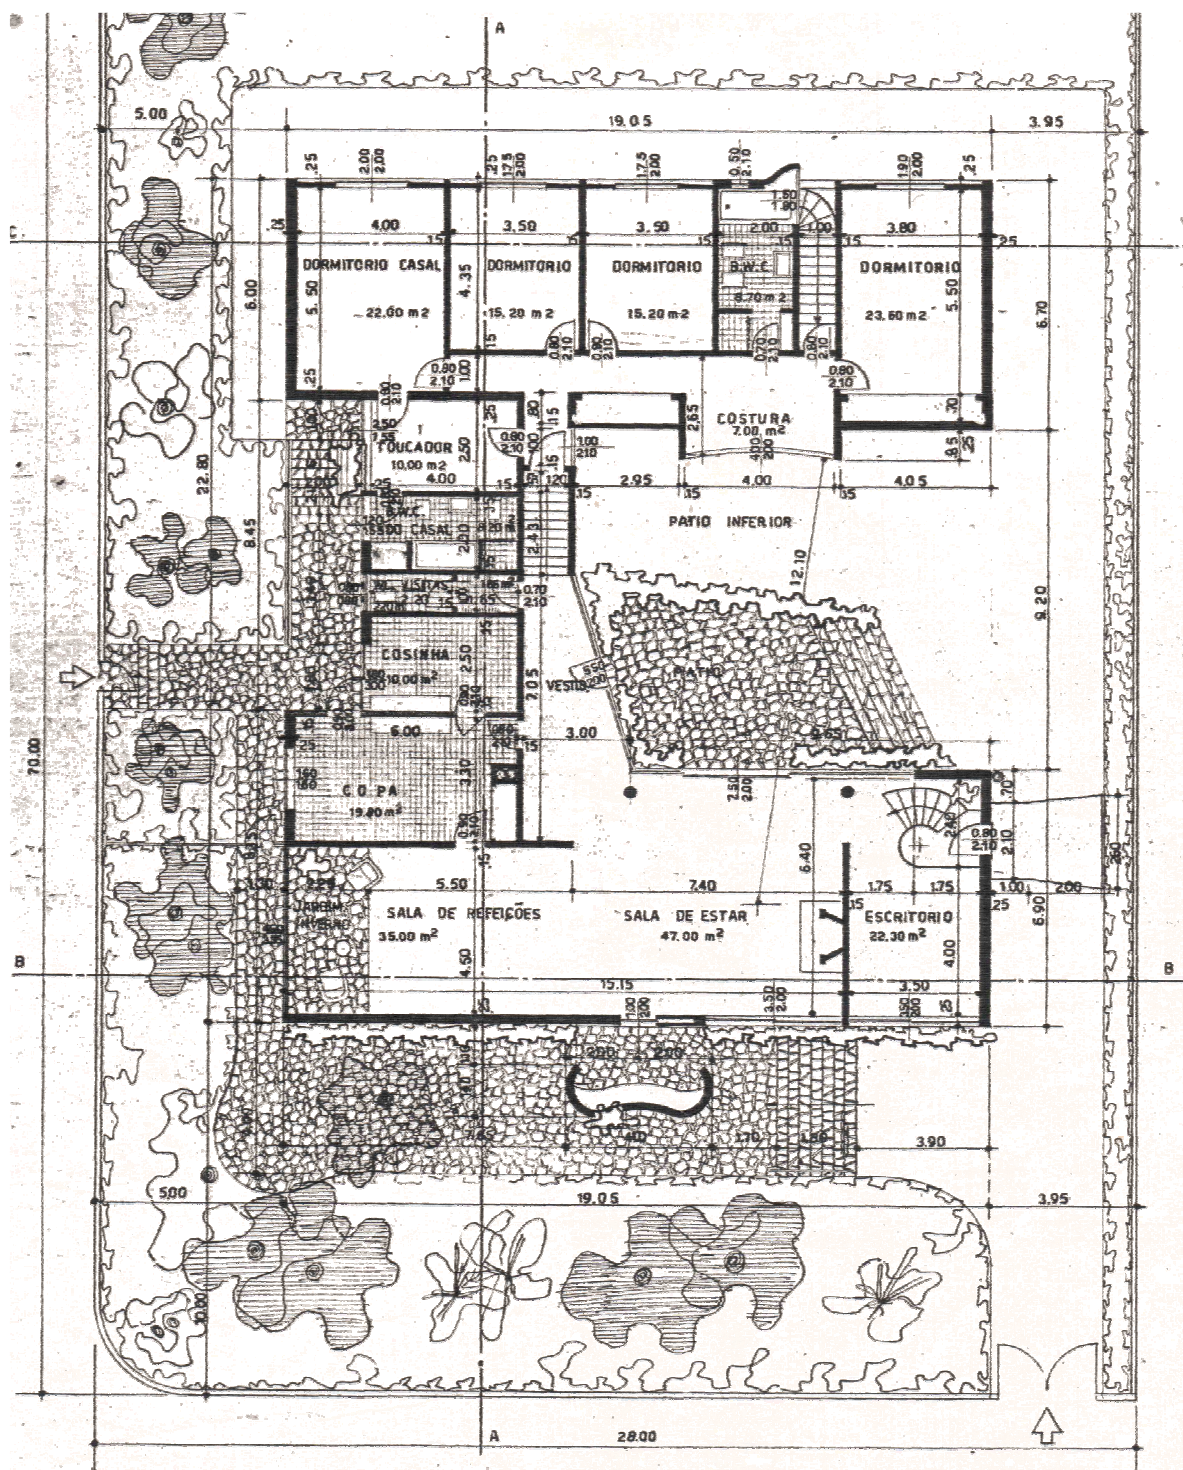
PLANTA PAVIMENTO TÉRREO E SUPERIOR
